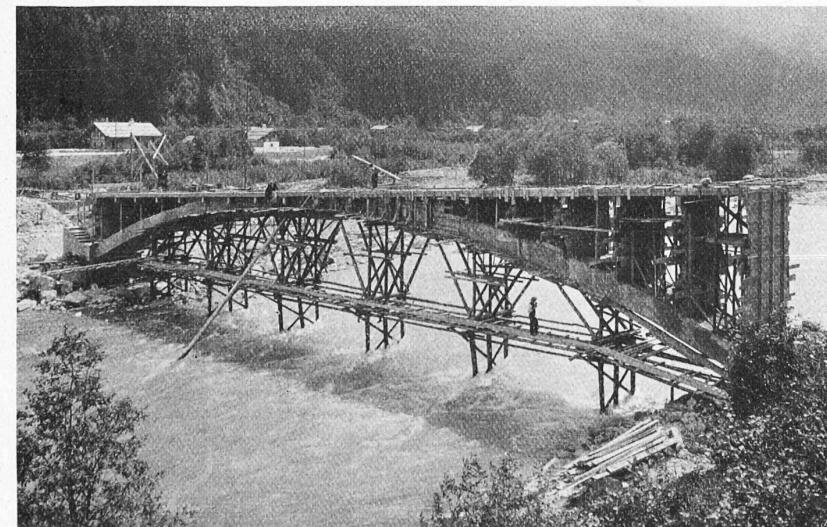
Rheinbrücke bei Waltensburg mit Lehrgerüst vom linken Ufer aus.
